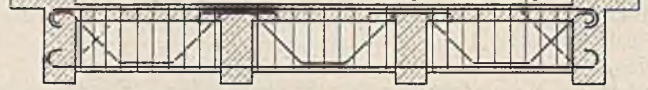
Zweckmäßige Bewehrung eines Eisenbetonträgerrostes.
